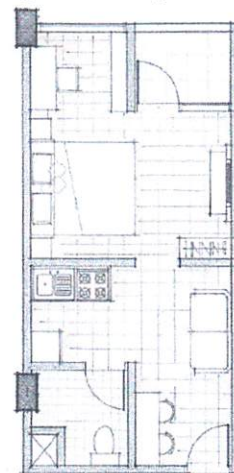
Zoning Horizontal dan Vertikal Bangunan
